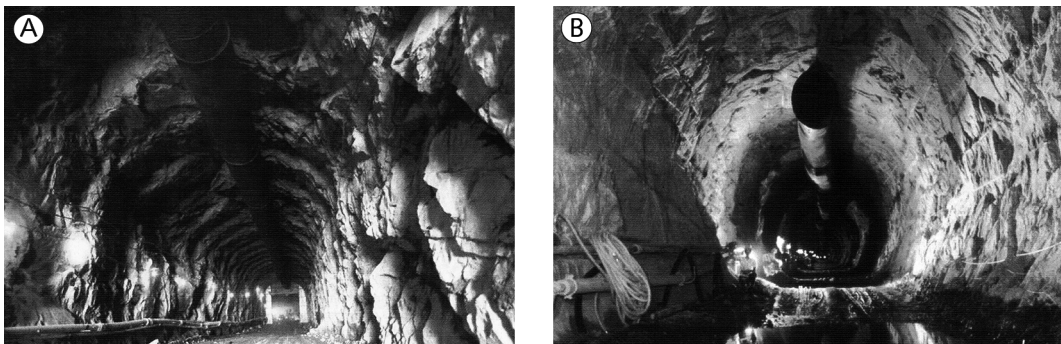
Exemplos de escavação: (A) com detonação ruim e (B) com detonação boa
